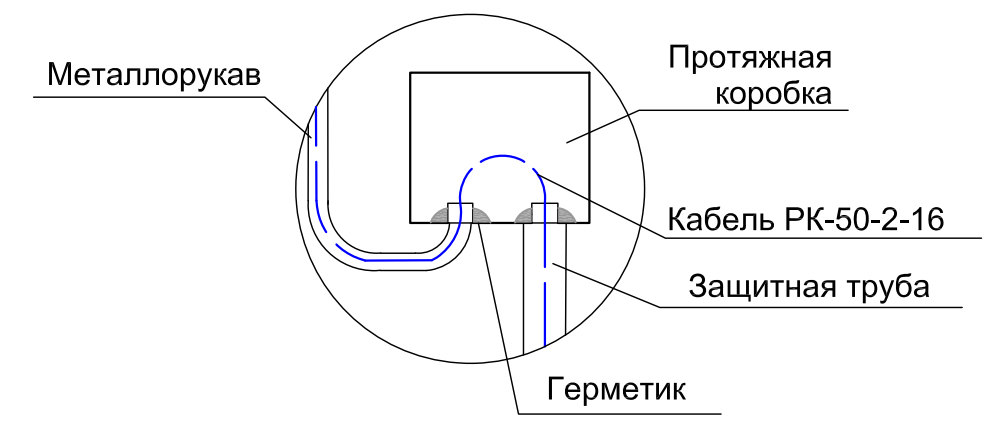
Прокладка соединительного кабеля через протяжную коробку
